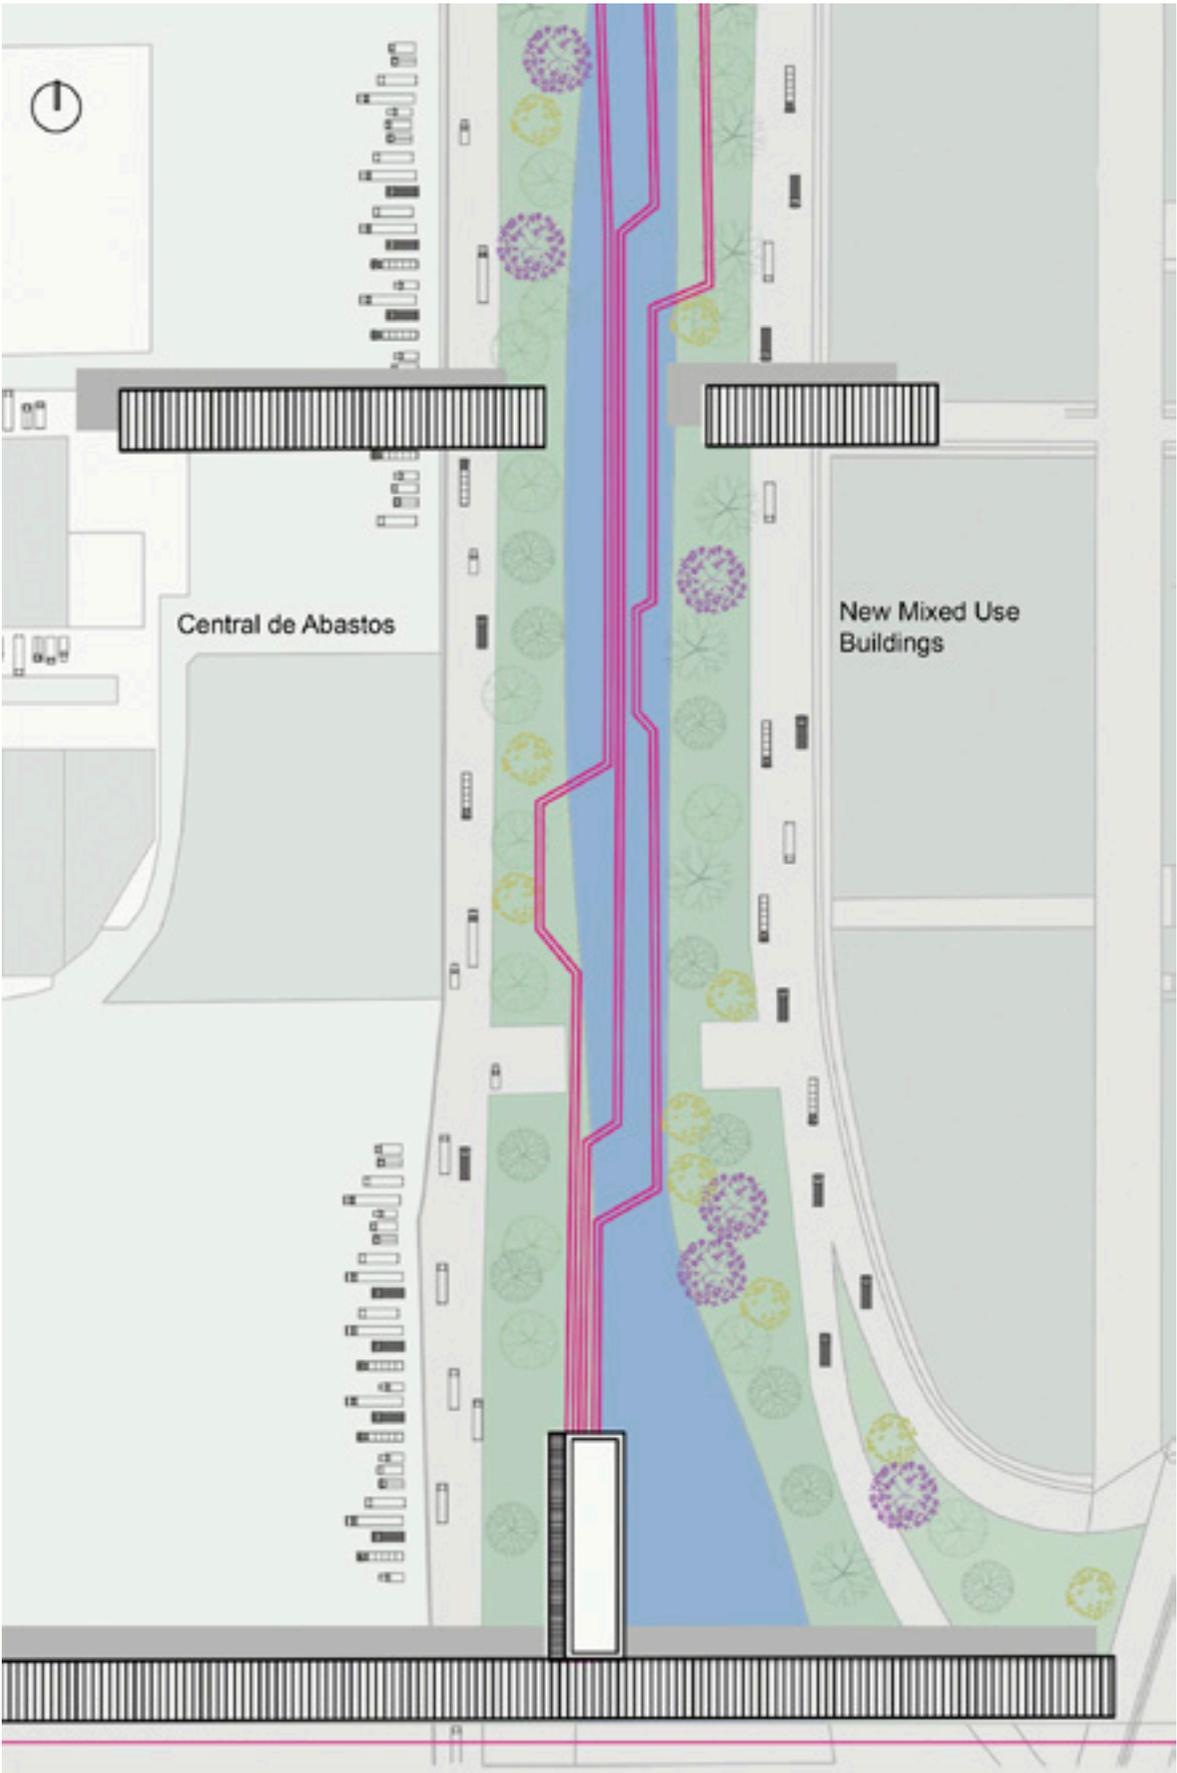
Detalle en planta de puente programático del proyecto.
